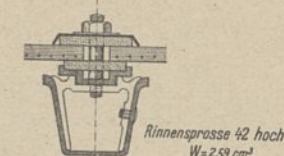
Querschnitt der Rinnensprossen für Lüftungshauben. 1:5.
